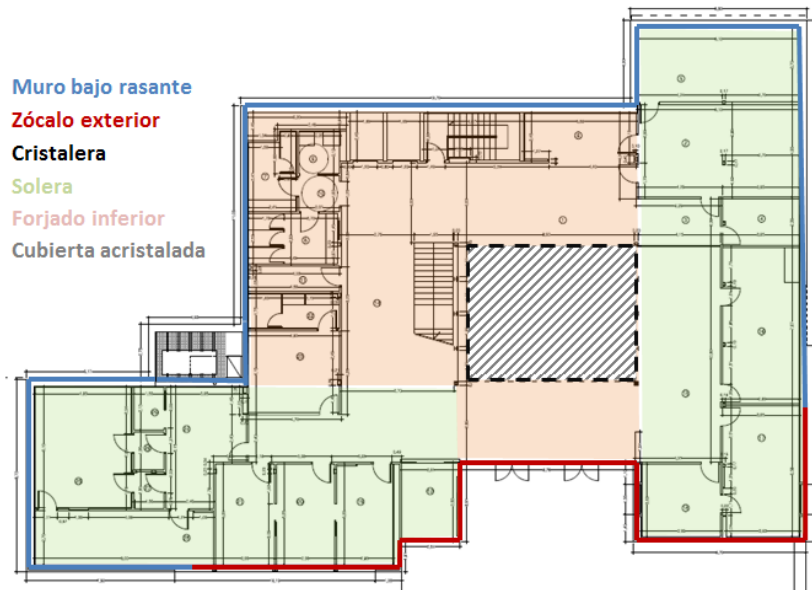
localización de cada cerramiento de la planta baja en plano acotado.
